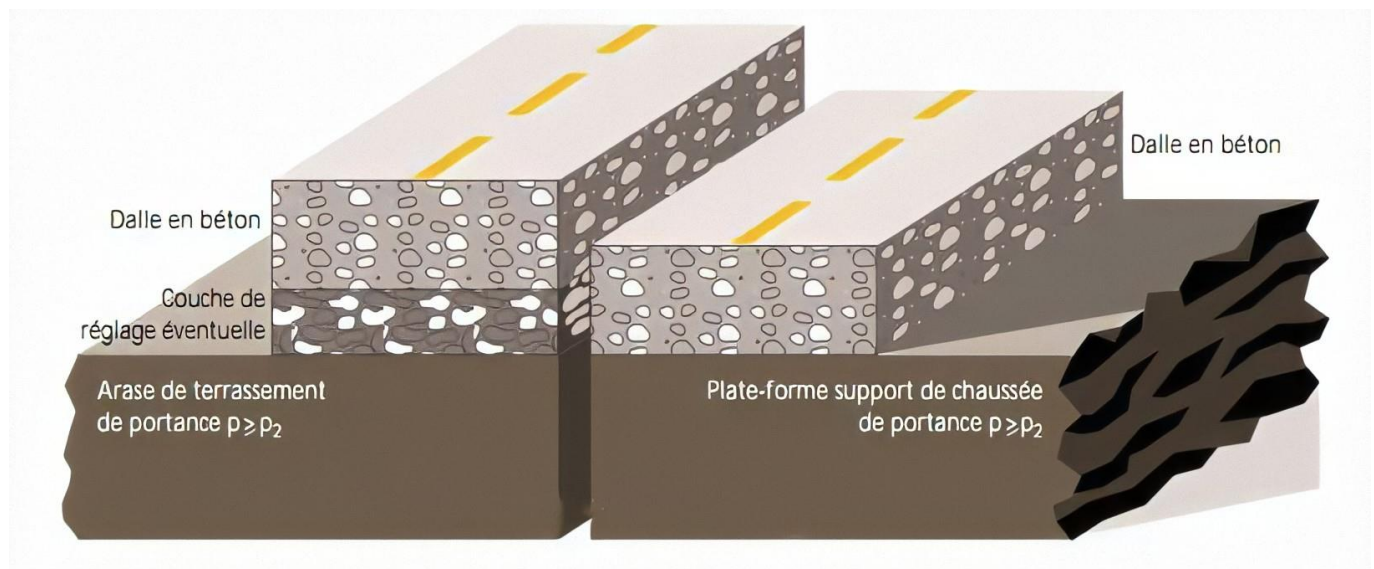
structure type d'une chaussée semi-rigide.
